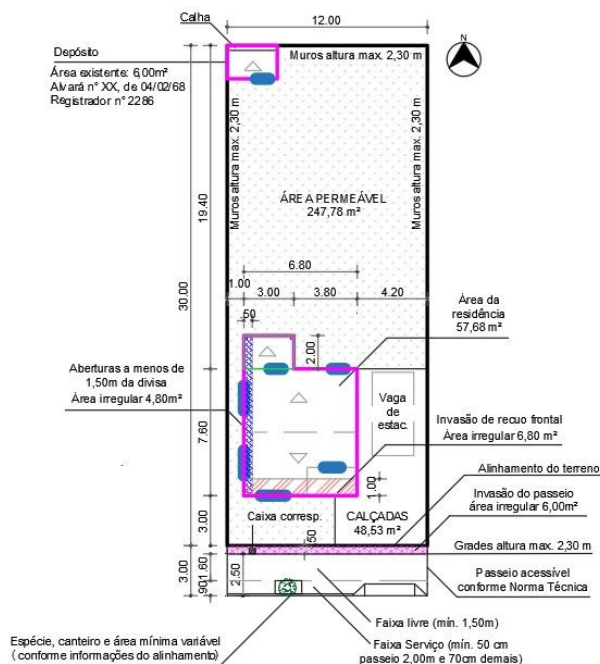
Croqui demonstrativo do projeto de localização – 01(um) pavimento – CONSTRUÇÃO (Projeto A)
